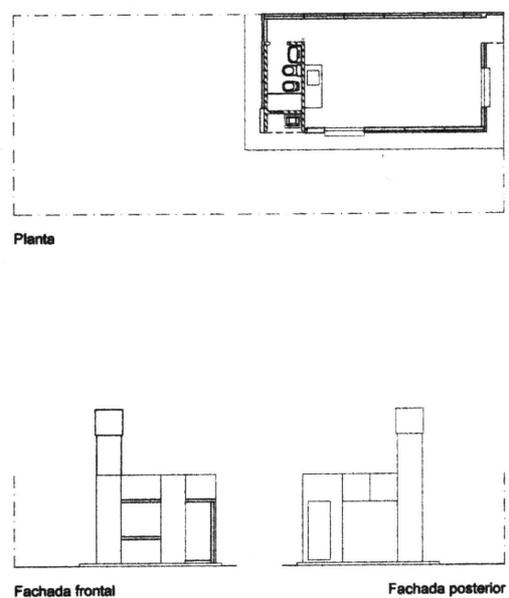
a. Planta y vista vivienda Colombres, DPVU
